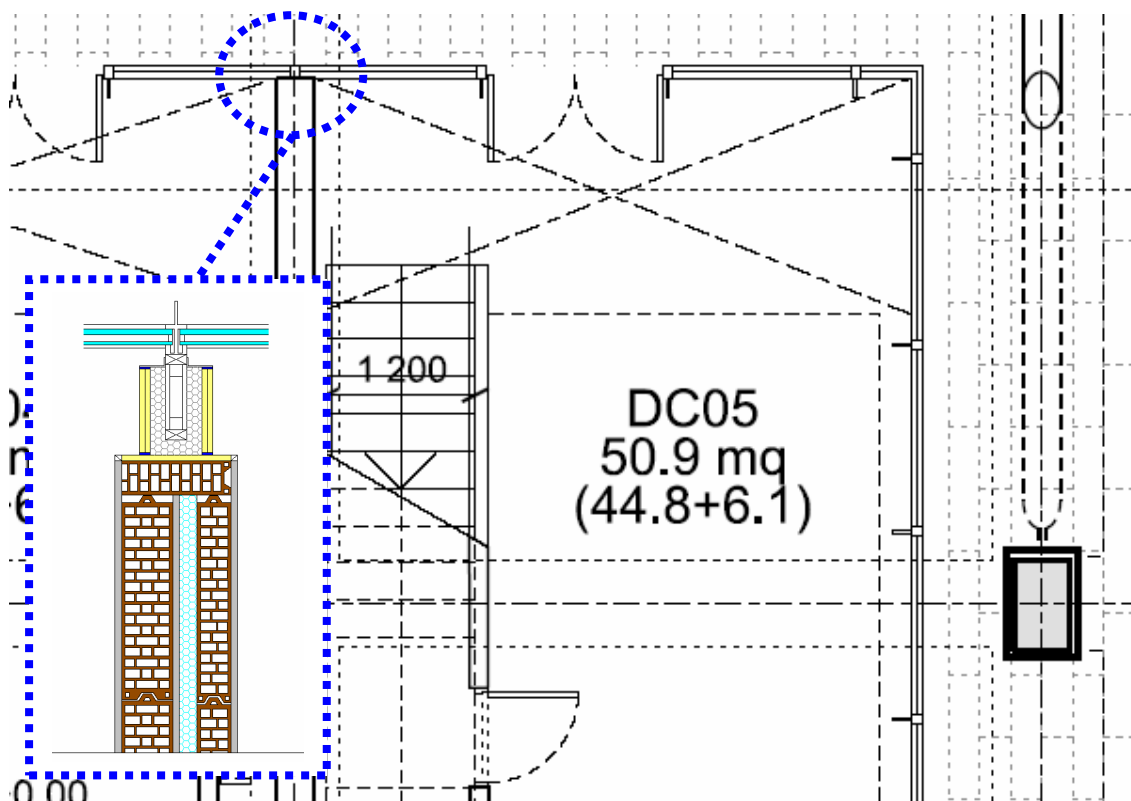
Indicazione in pianta degli elementi leggeri di facciata non rigidamente connessi
